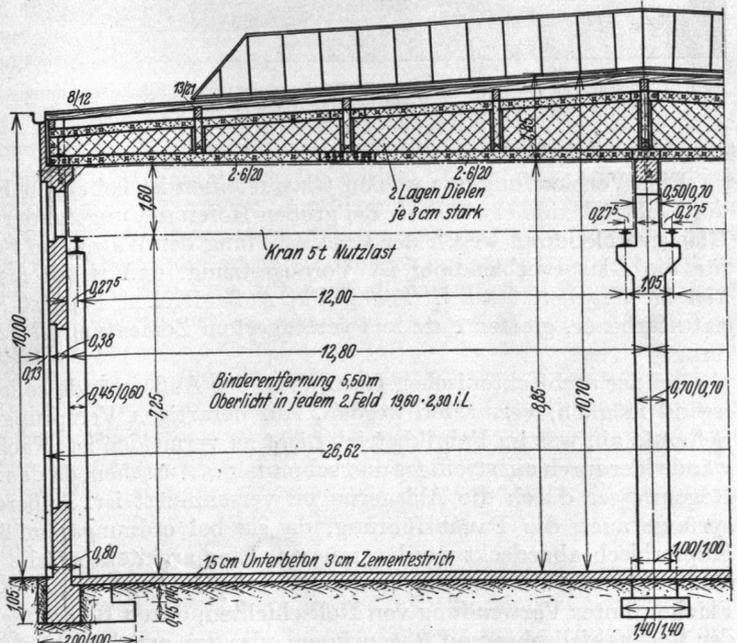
Werkstatthalle in kombinierter Bauweise: Umfassungswände in Mauerwerk, Stützen in Eisenbeton, Binder in Vollwand-Holzkonstruktion.
